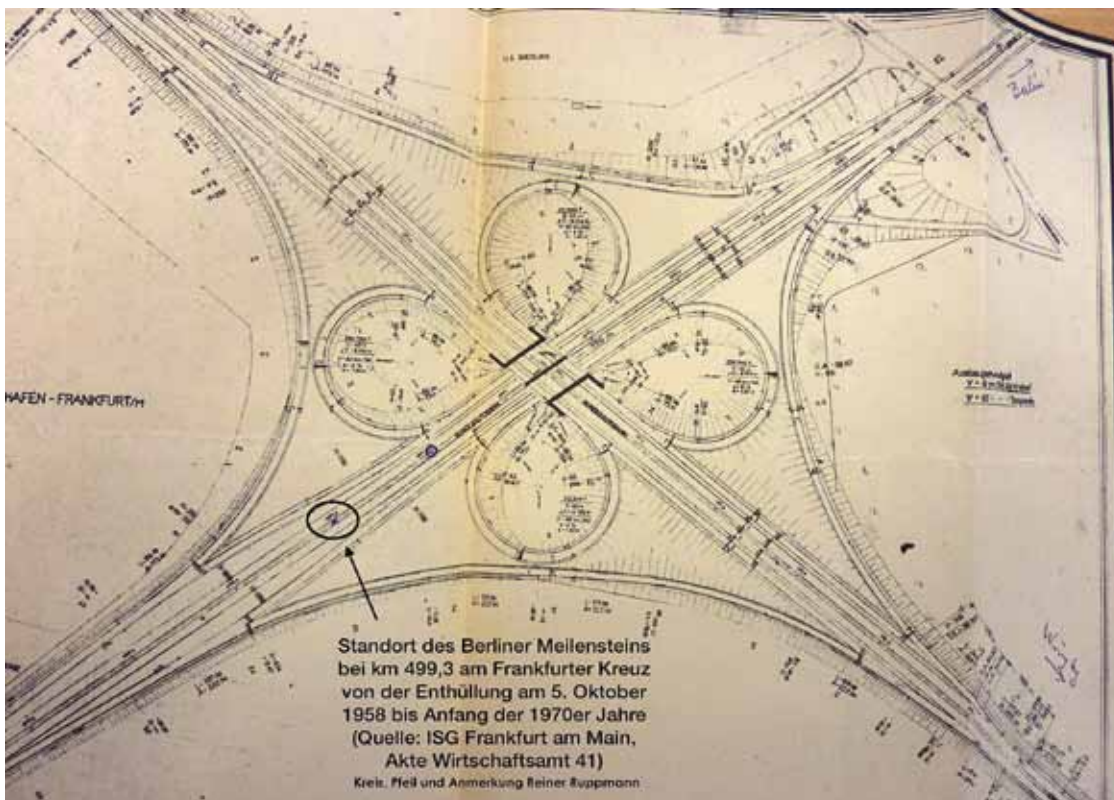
Lageplan für den Standort 1958 des Berliner Meilensteins Einzeichnungen und Beschriftung: Reiner Ruppmann
